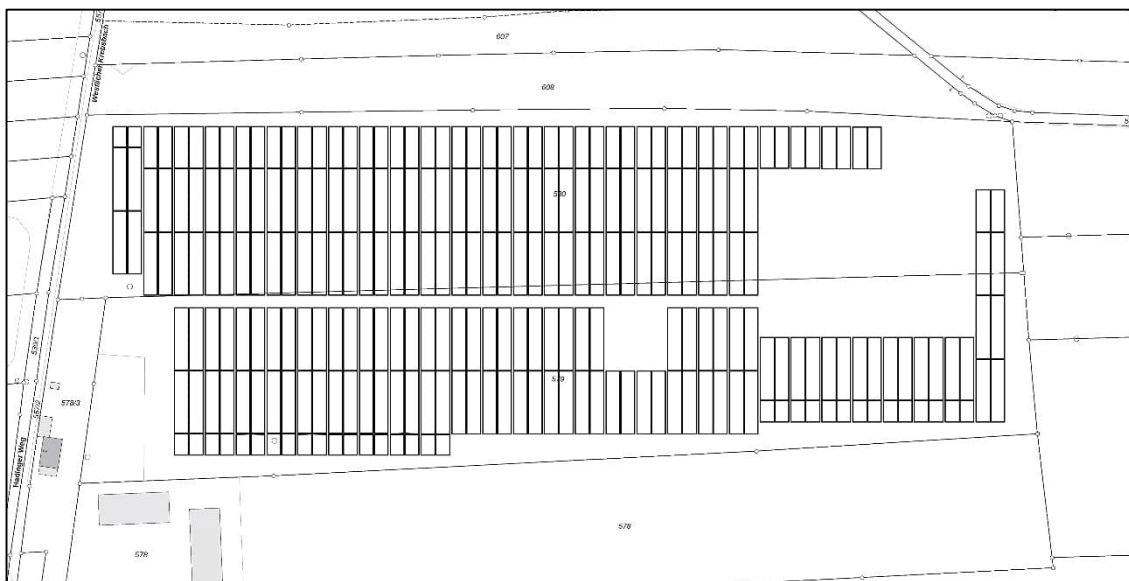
Lageplan der geplanten PV-Anlage /7/
